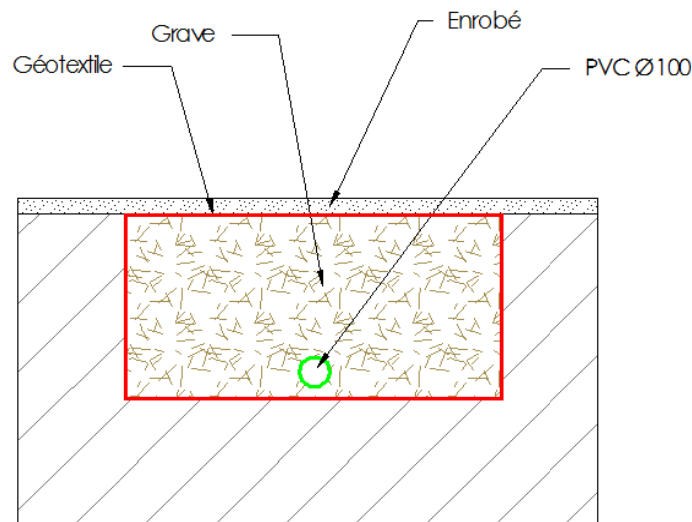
Principe de conception d'une structure réservoir avec revêtement de surface étanche
